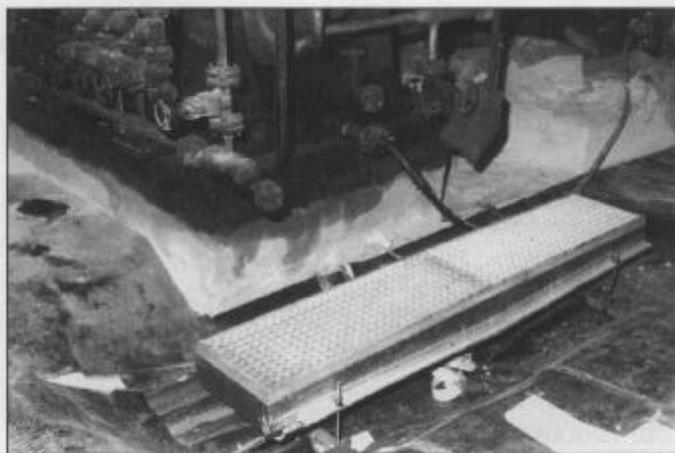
Edelstahlrinne mit Anschluß an das Sielsystem vor dem Einbau der Betonfläche
